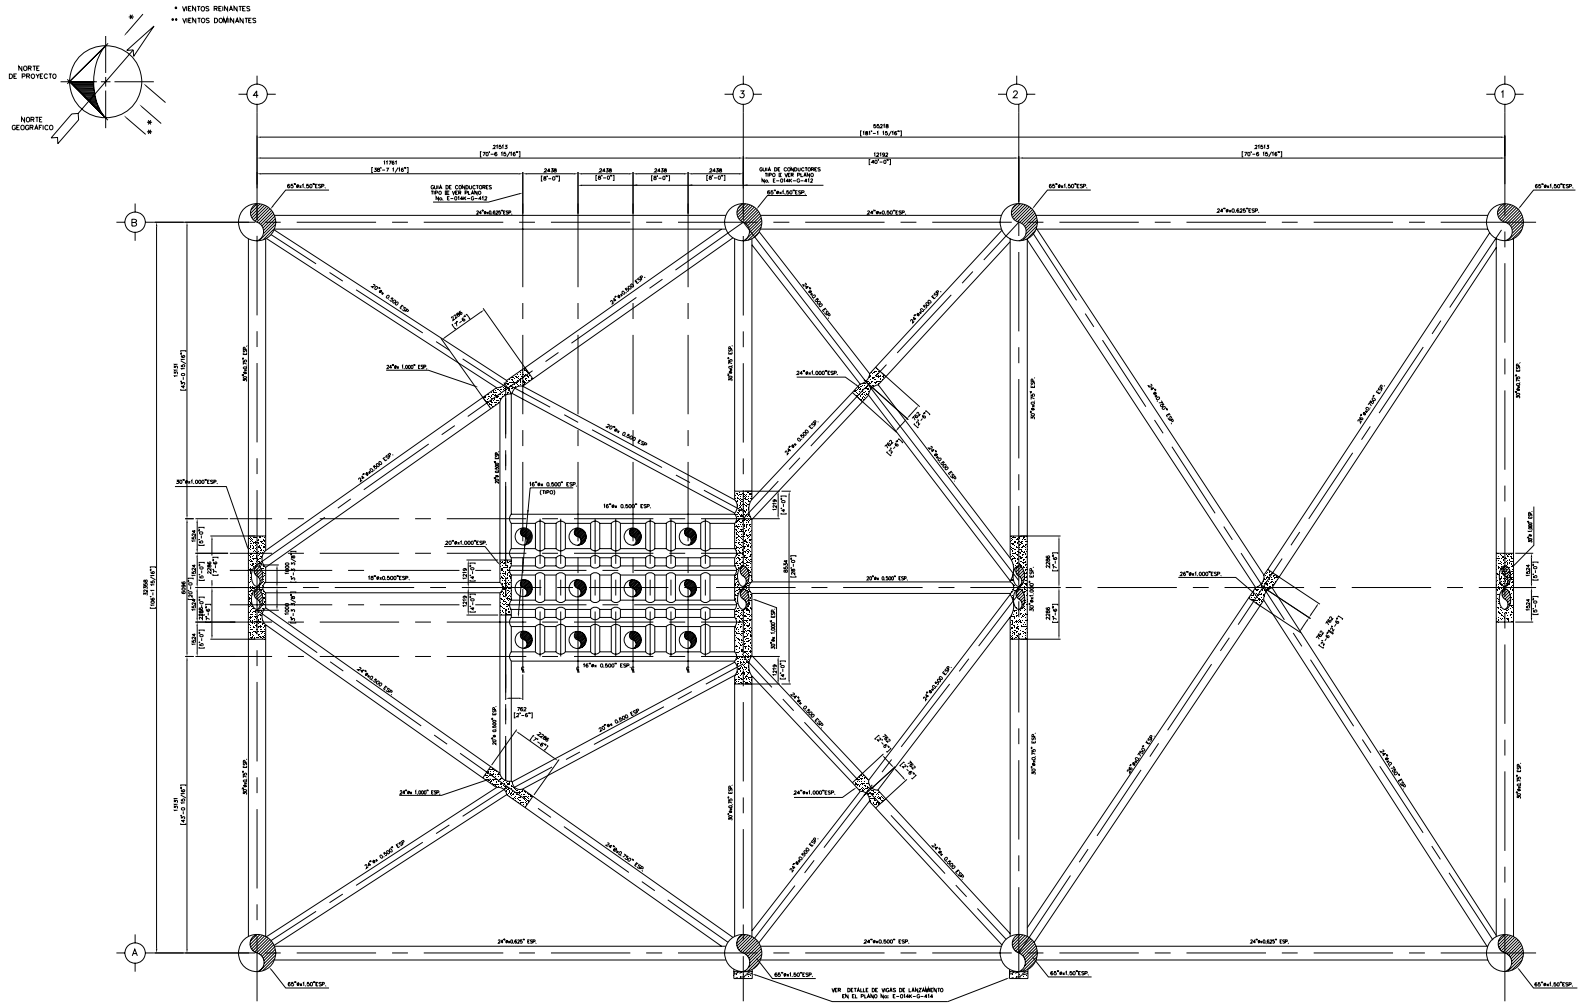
Planta en elevación (-) 84.000 m (209-11 11/16”).
